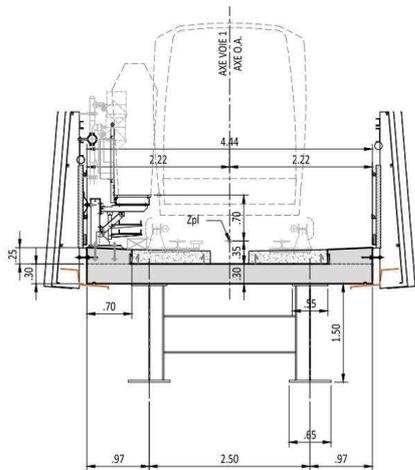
Coupe transversale de l'ouvrage en travée – (Source : Etudes AVP1)
